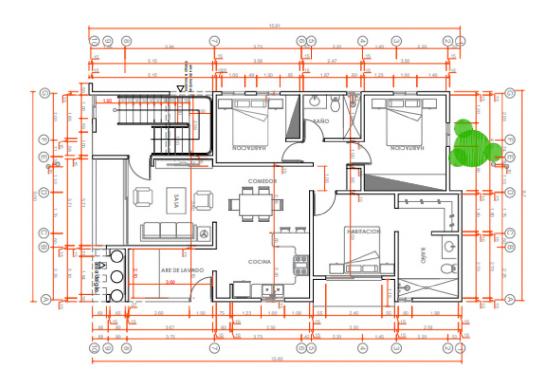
Planta dimensionada del 1ro al 4to nivel
